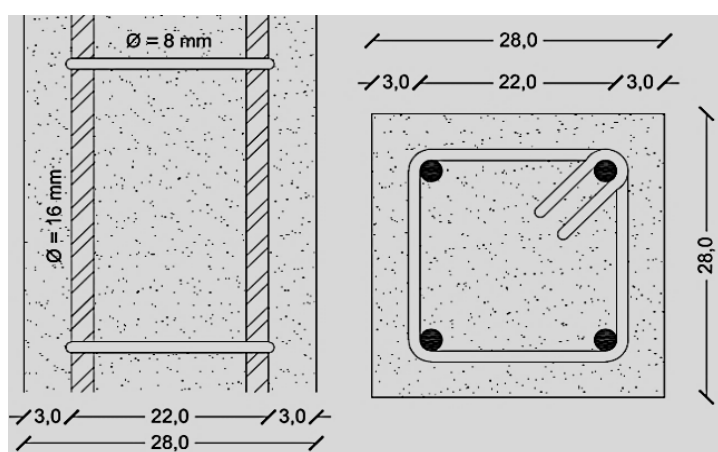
Representação esquemática das seções transversal e longitudinal dos pilares P1 e P2, medindo 28x28 cm de seção transversal, com recobrimento de 3,0 cm e as armaduras principais com bitola de 16 mm e estribos com bitola de 8 mm.
